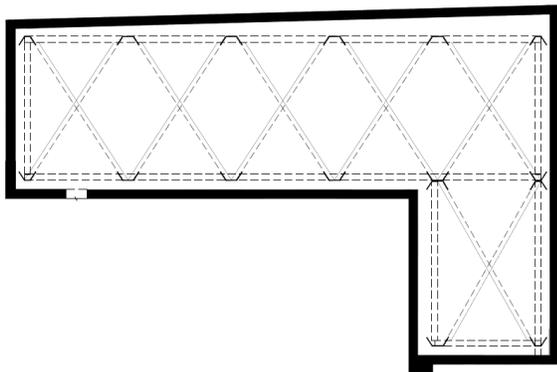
Planta estructural esquemática talleres. Elaboración propia. 2014
